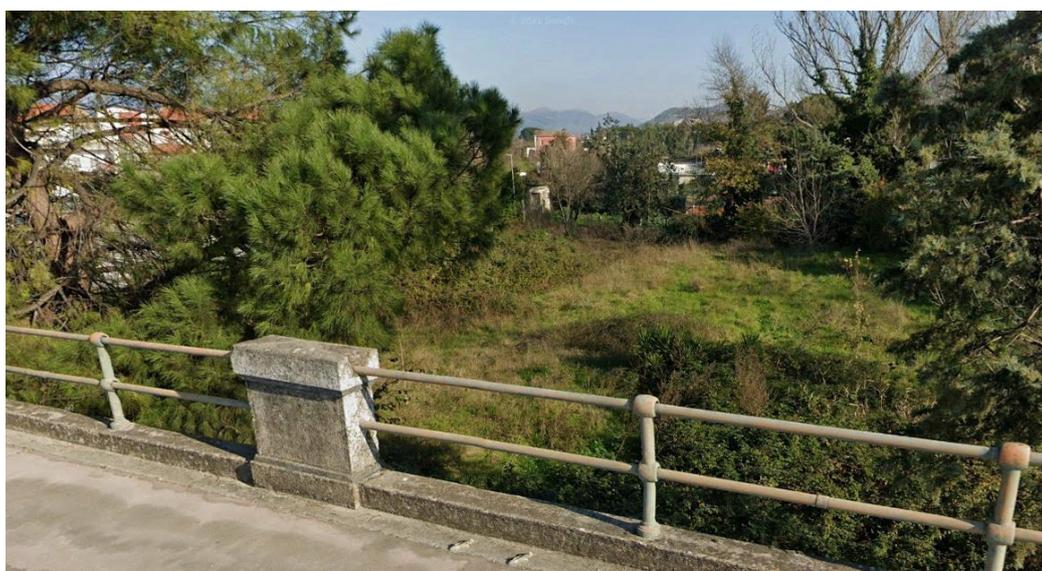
Foto 15 – inquadramento area interessata dalle opere di connessione (elettrodotto aereo)
